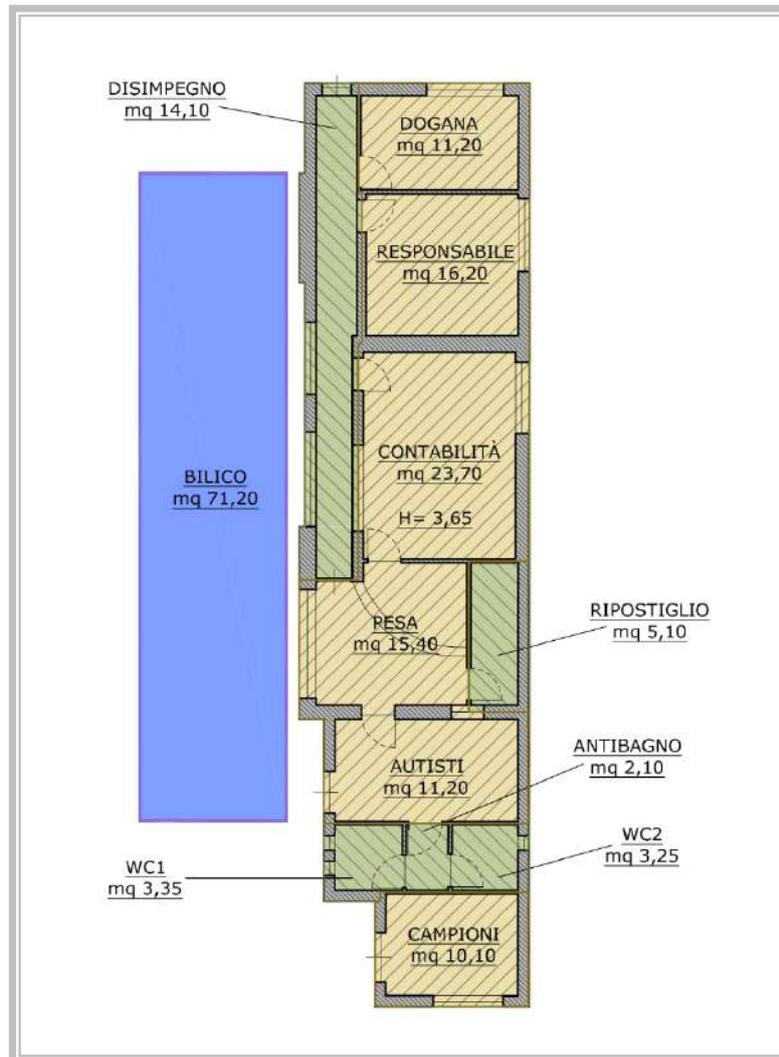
Lotto 7 – Uffici di movimentazione
